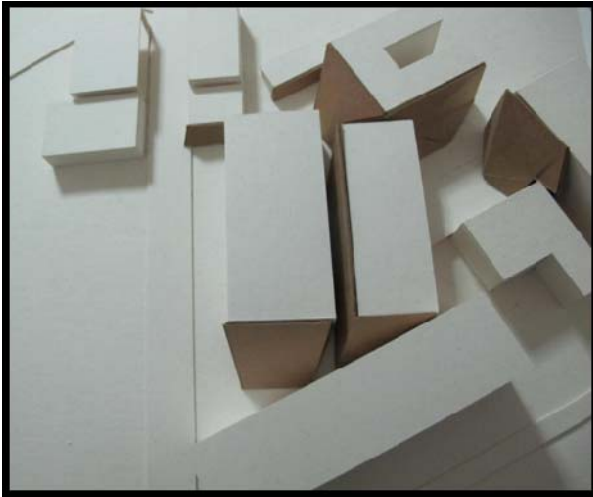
ระนาบแนวนอน (Floor PLane) กับการเล่นแบบไทย และสากล
